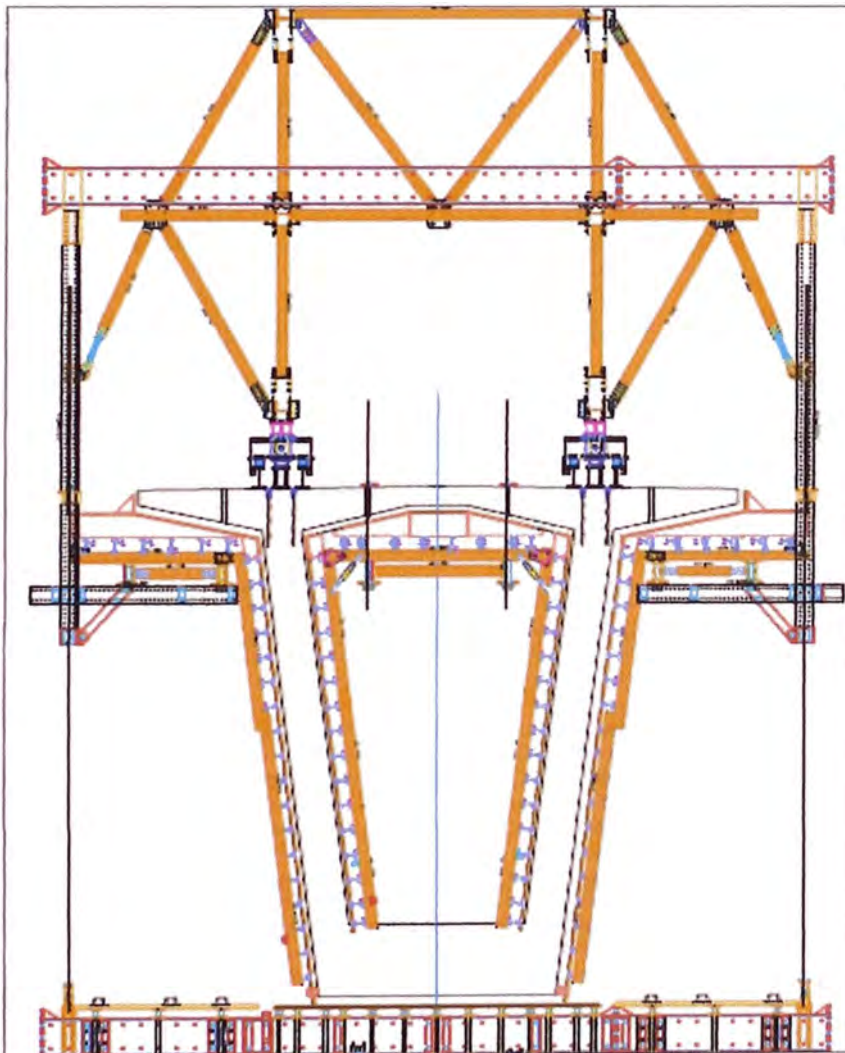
Desencofrado de fondo, interior y exterior.
